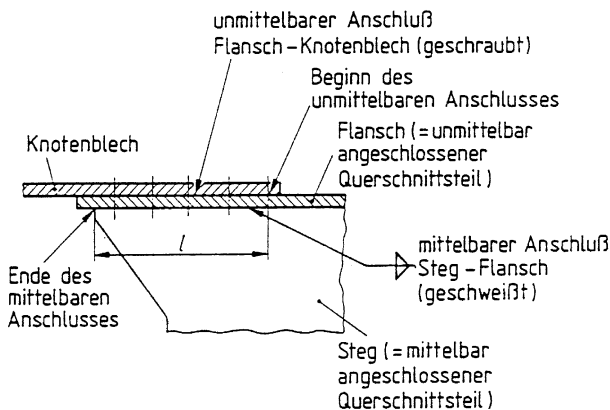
Mittelbarer Anschluss bei zusammengesetzten Querschnitten.
